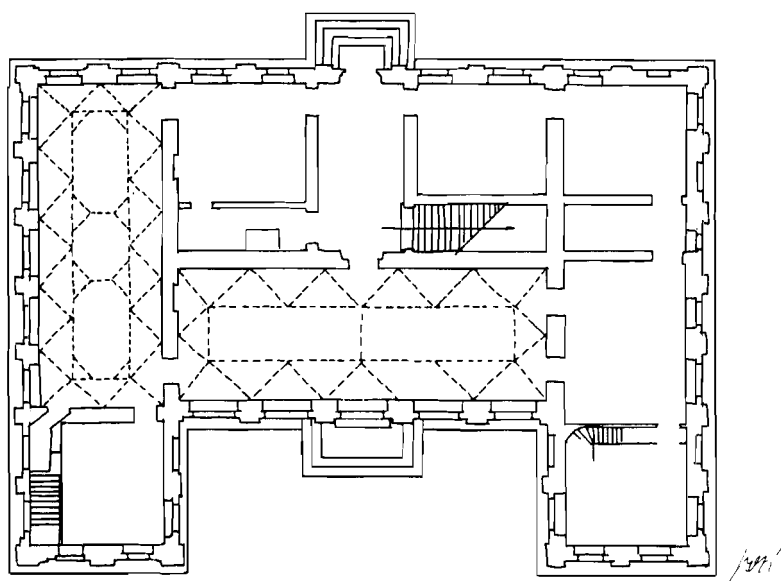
B. Peruzzi: *Ia Farnesina*. Planta (croquis). Detalle del Alzado (s./ Josef Durm).
